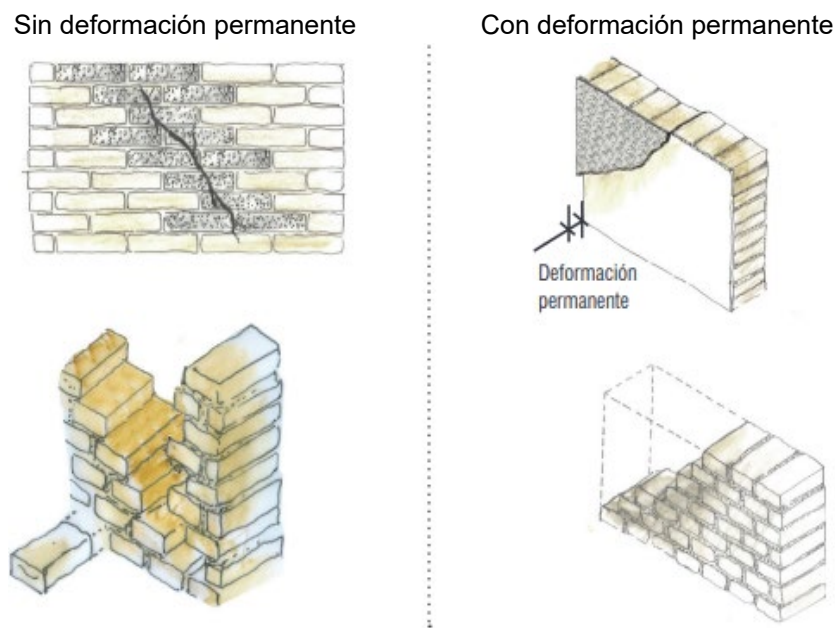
Reparación de grietas mayores a 20mm.
